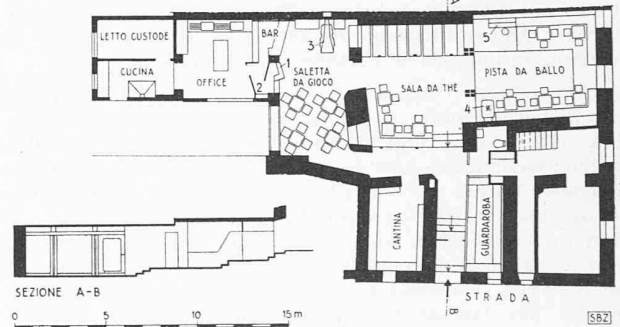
Tavernetta «Shangri-là» in Bormio. Grundriss 1 : 400. 1 Kasse, 2 Telephon, 3 Kaminofen, 4 Ofen, 5 Klavier
